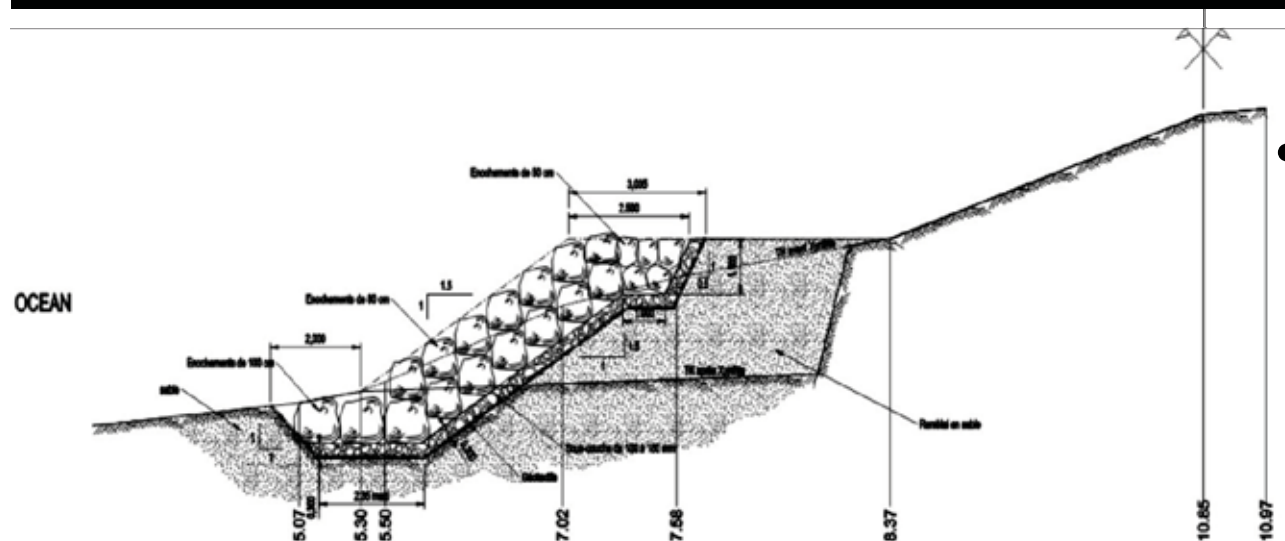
protection de cordon dunaire par enrochements (plan ISL).
